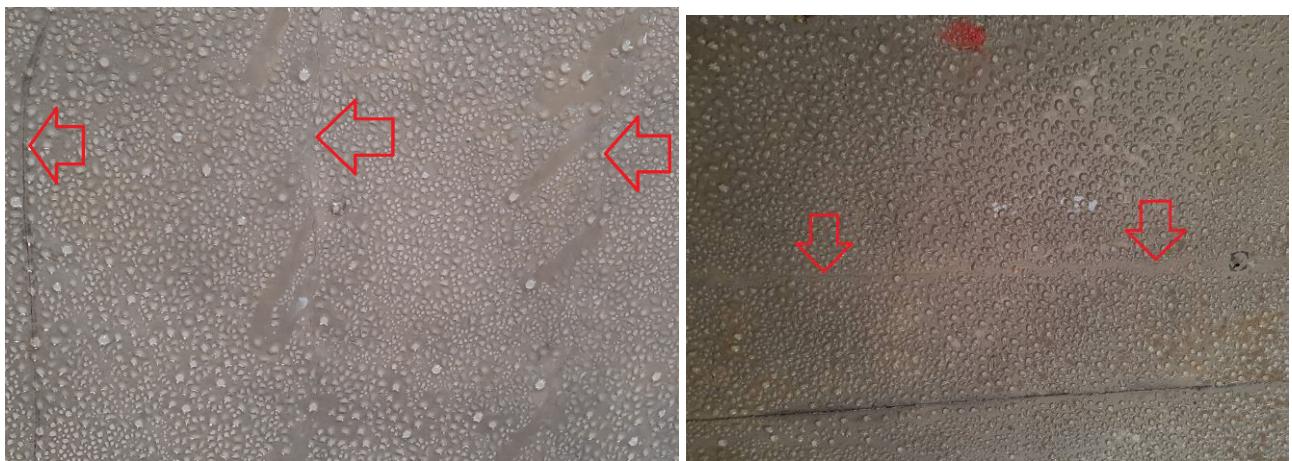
, 54 Растрескивания плиты перекрытия на отметке +8900.
